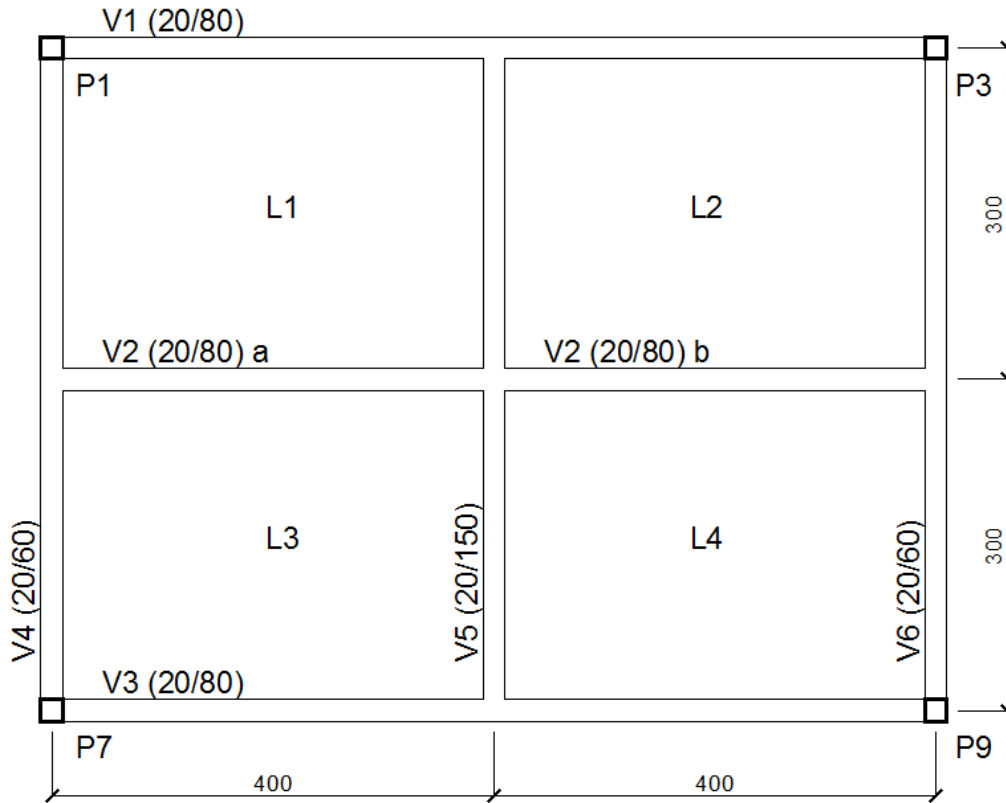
Exemplo 4 - Planta esquemática da forma do pavimento.
